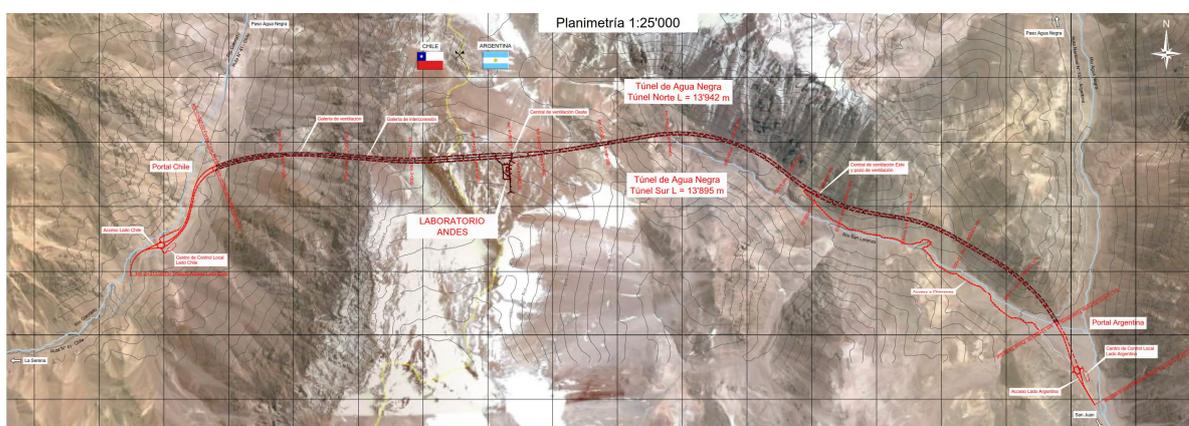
Planimetría general Túnel de Agua Negra con emplazamiento Laboratorio ANDES
